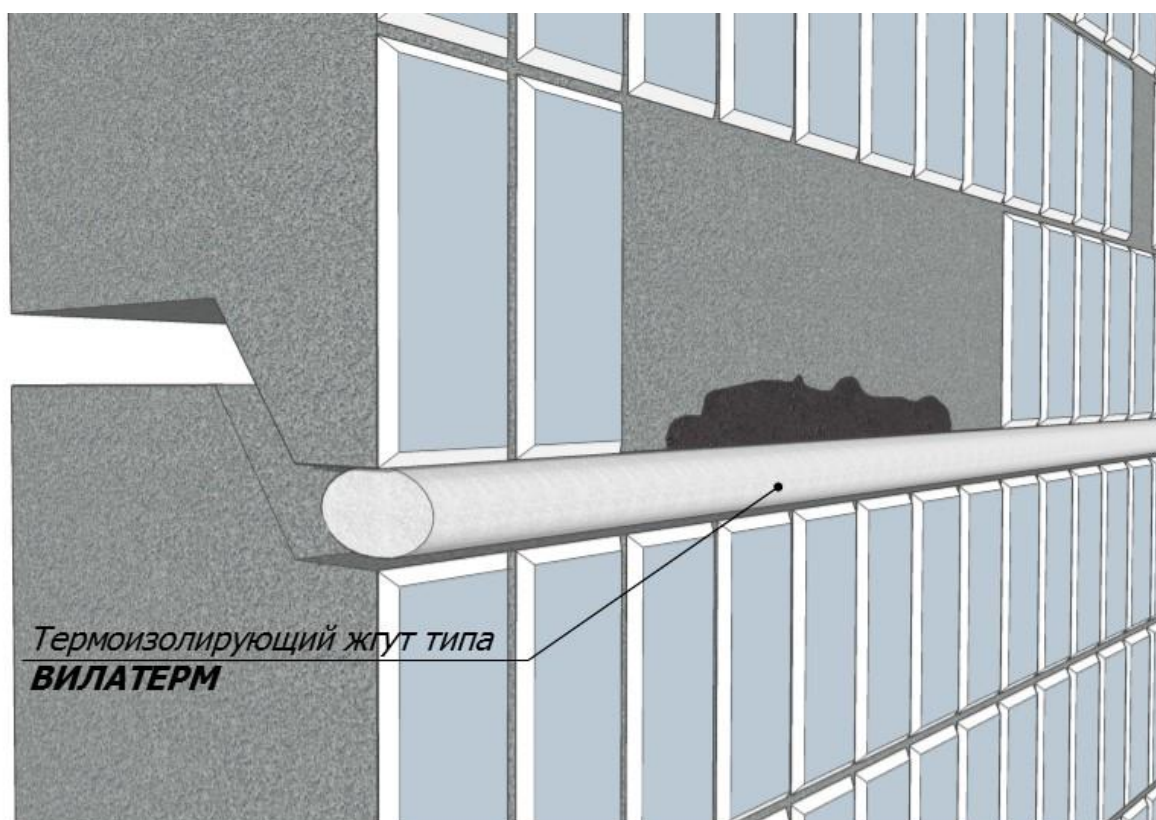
Установка уплотняющего термоизолирующего жгута.
